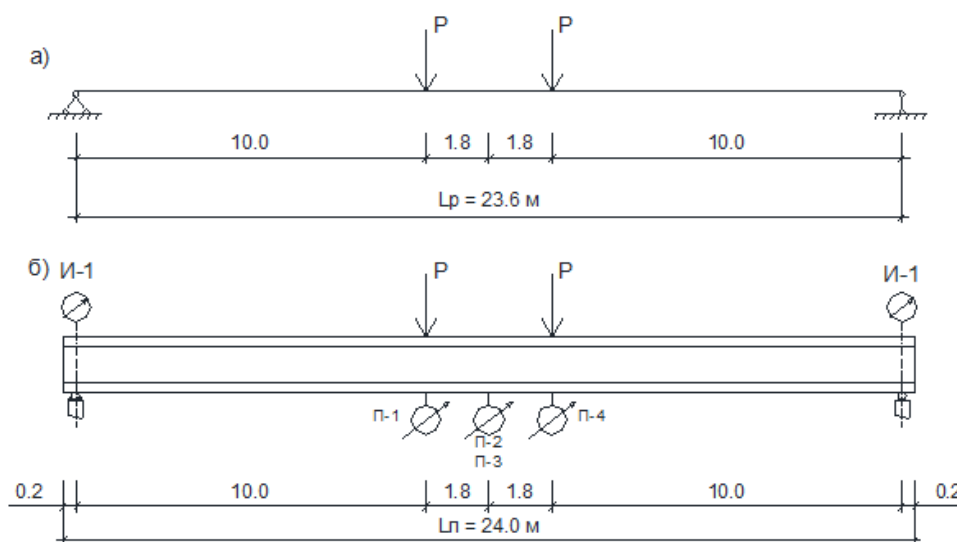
Расчетная схема испытаний мостовой балки ВТК-24У (а) и схема расположения механических приборов (б)
